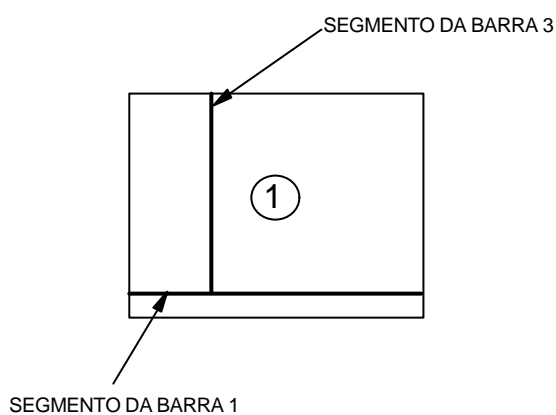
Segmentos de barras no interior do elemento de concreto
